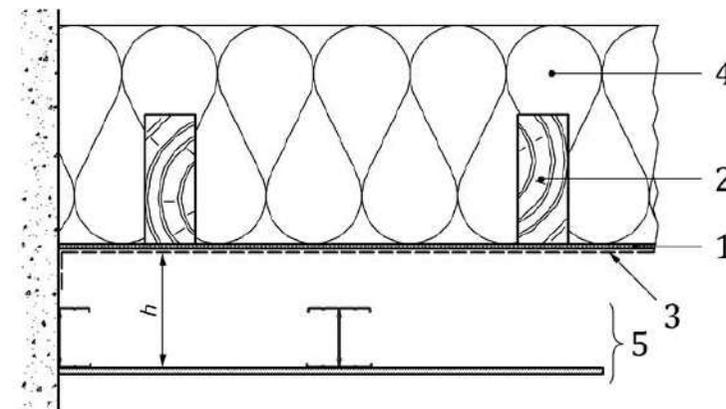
Membrane en sous-face du support avec création d'un plenum en plafond auto-portant
